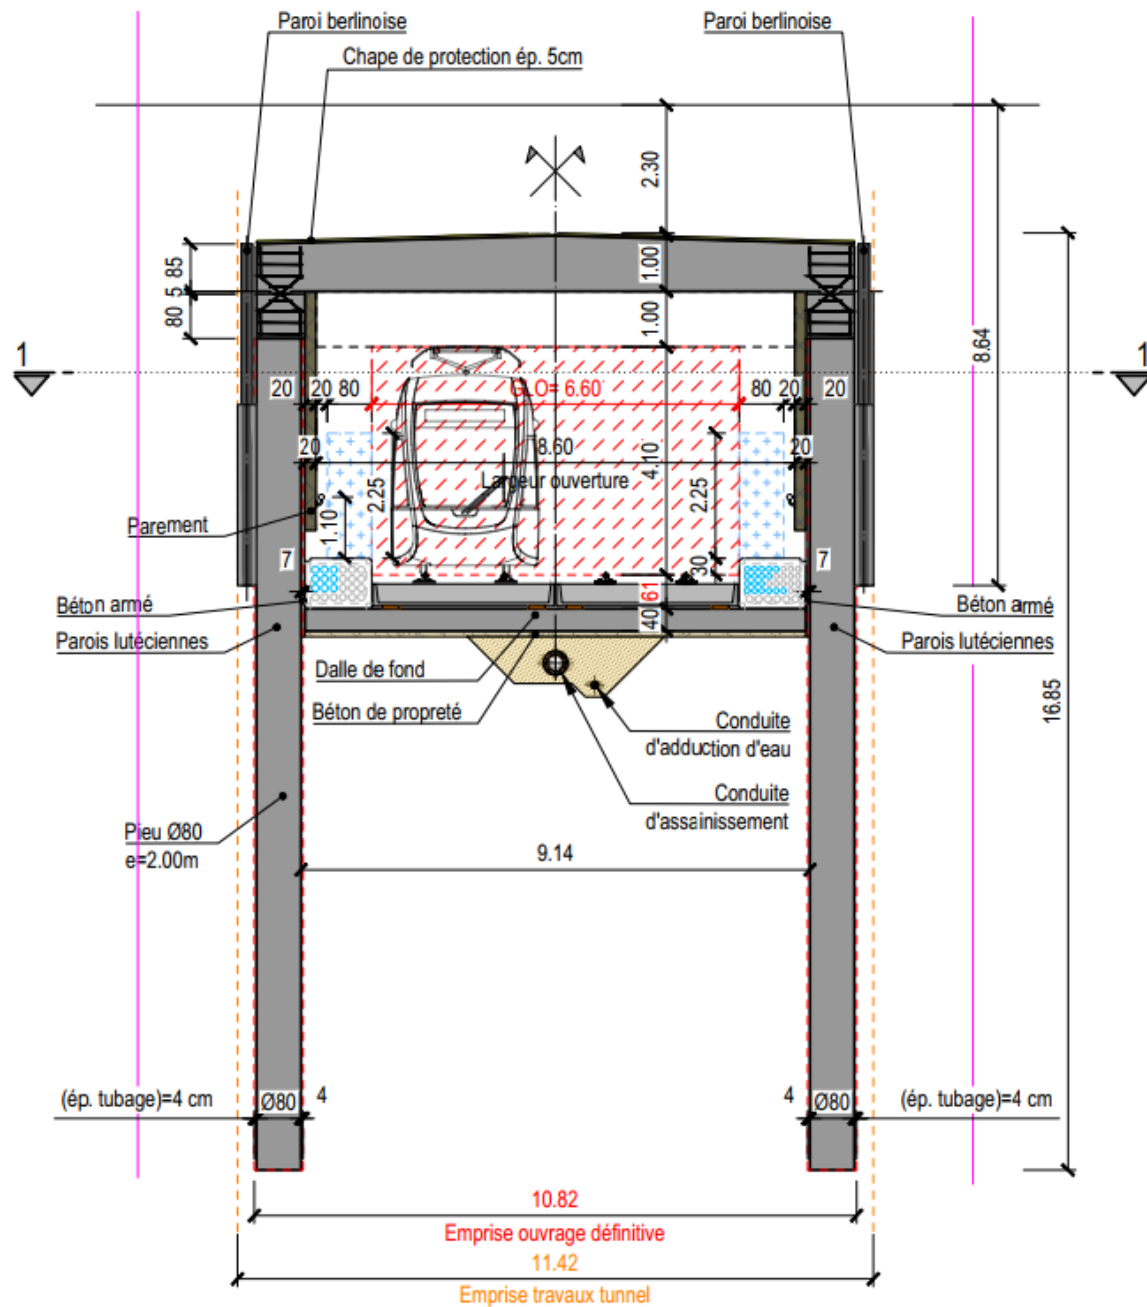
Coupe type de la tranchée couverte en section courante. Source : APS – Volume D, 2024
